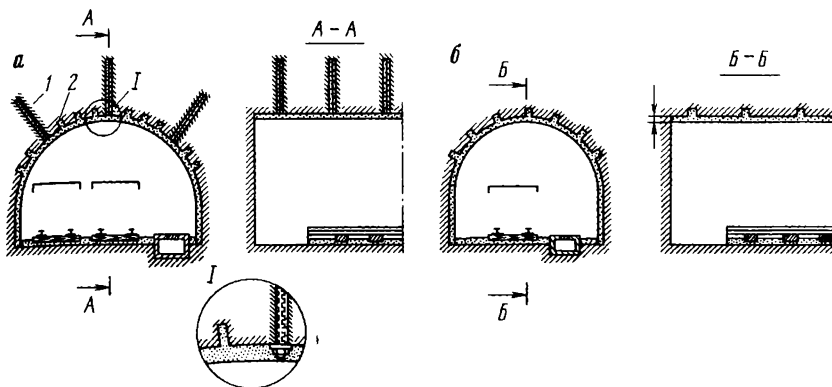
Варианты анкерно-набрызгбетонных крепей конструкции ВНИИОМШС для выработок:
